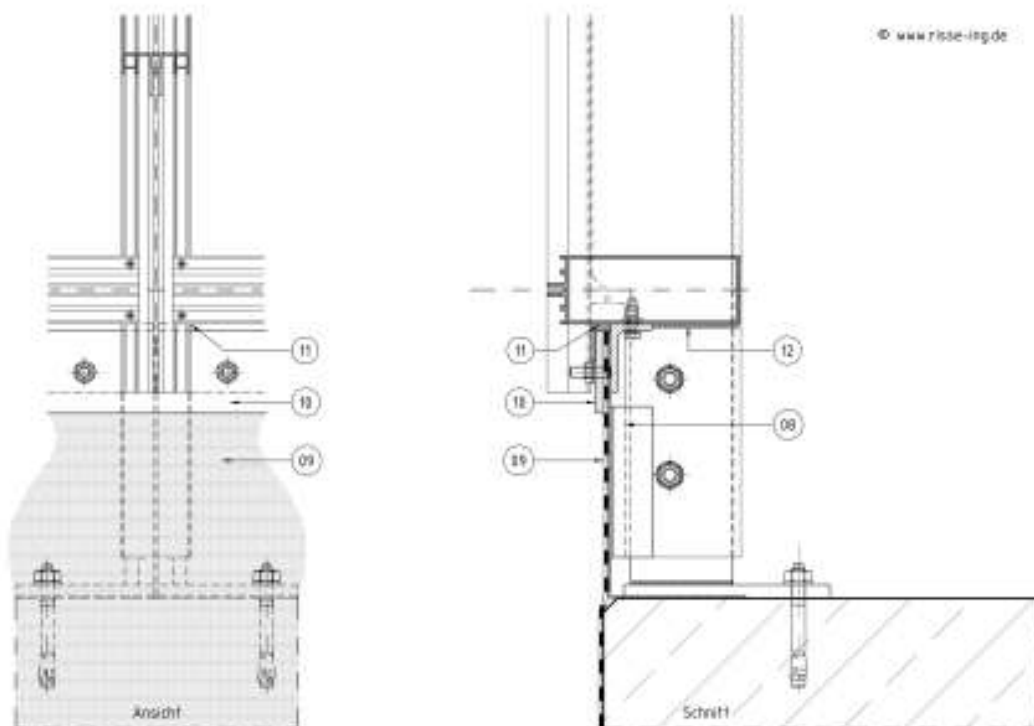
Fußpunkt Schritt 2: Anschluss der Bauwerksabdichtung
